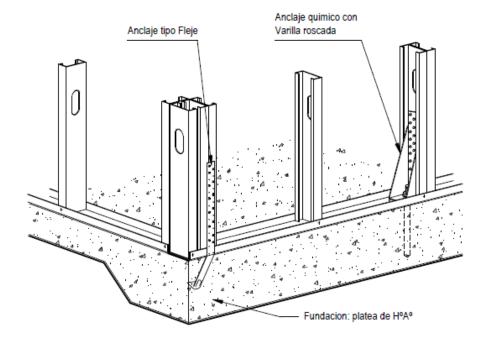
Tipología de anclajes para platea de hormigón. Fuente: (ConsulSteel, 2014).
